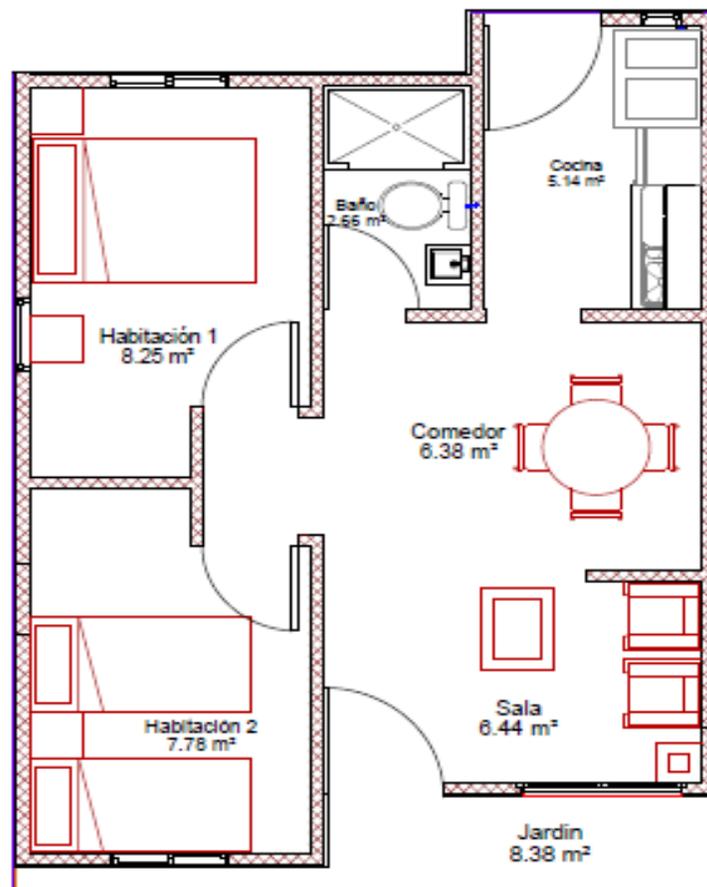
, Planta Arquitectónica (Fuente Propia)
